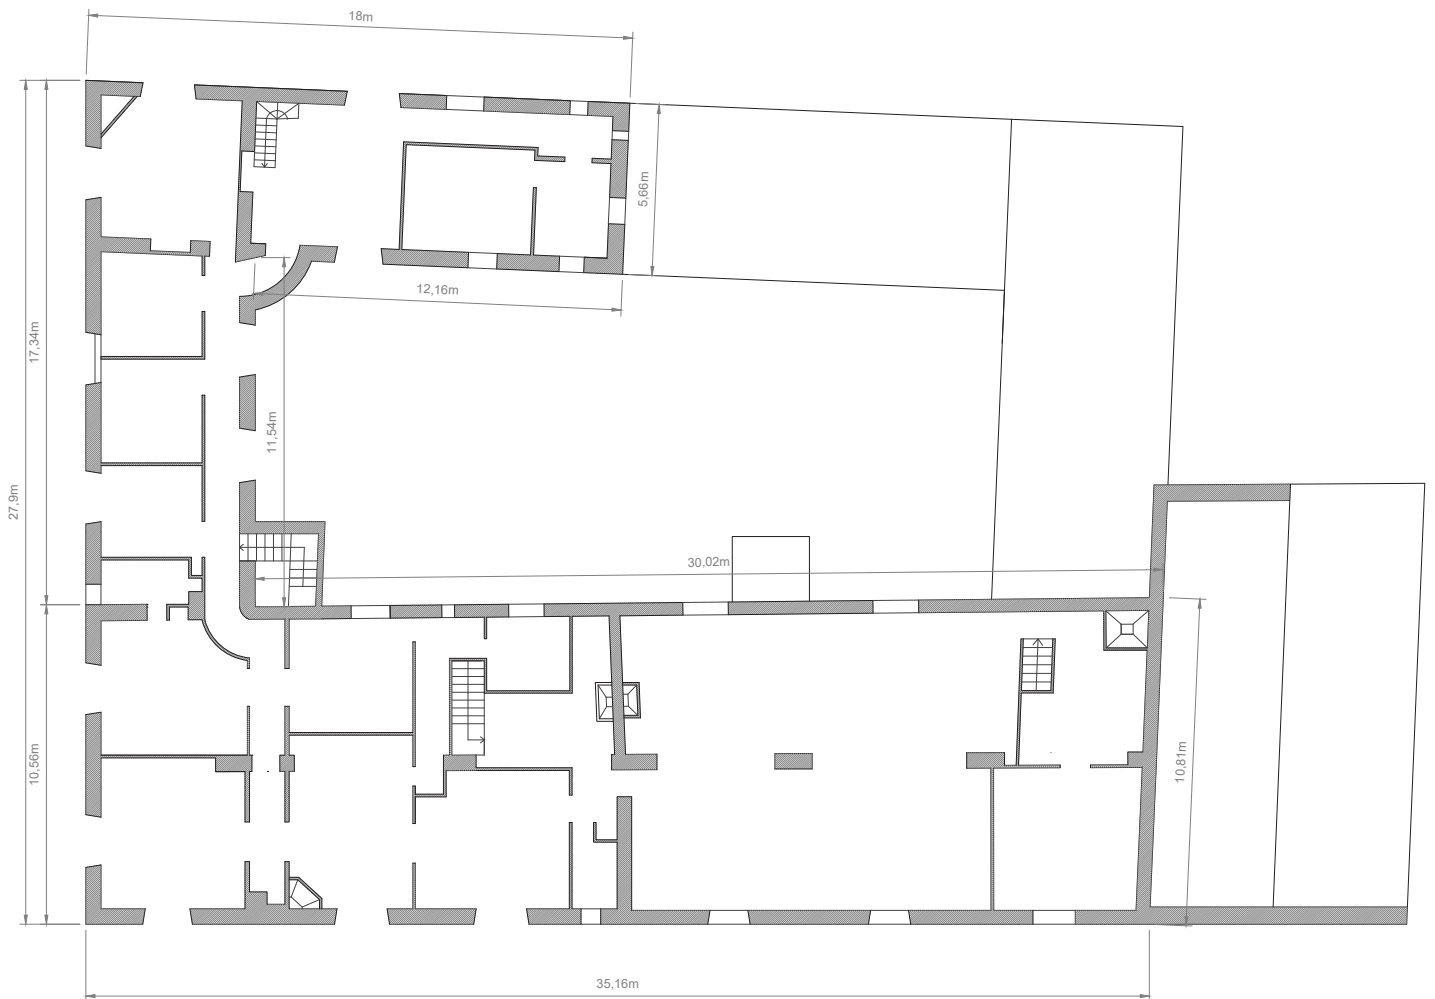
Plano de la planta baja de la Alquería de la Torre - producción propia (12)
